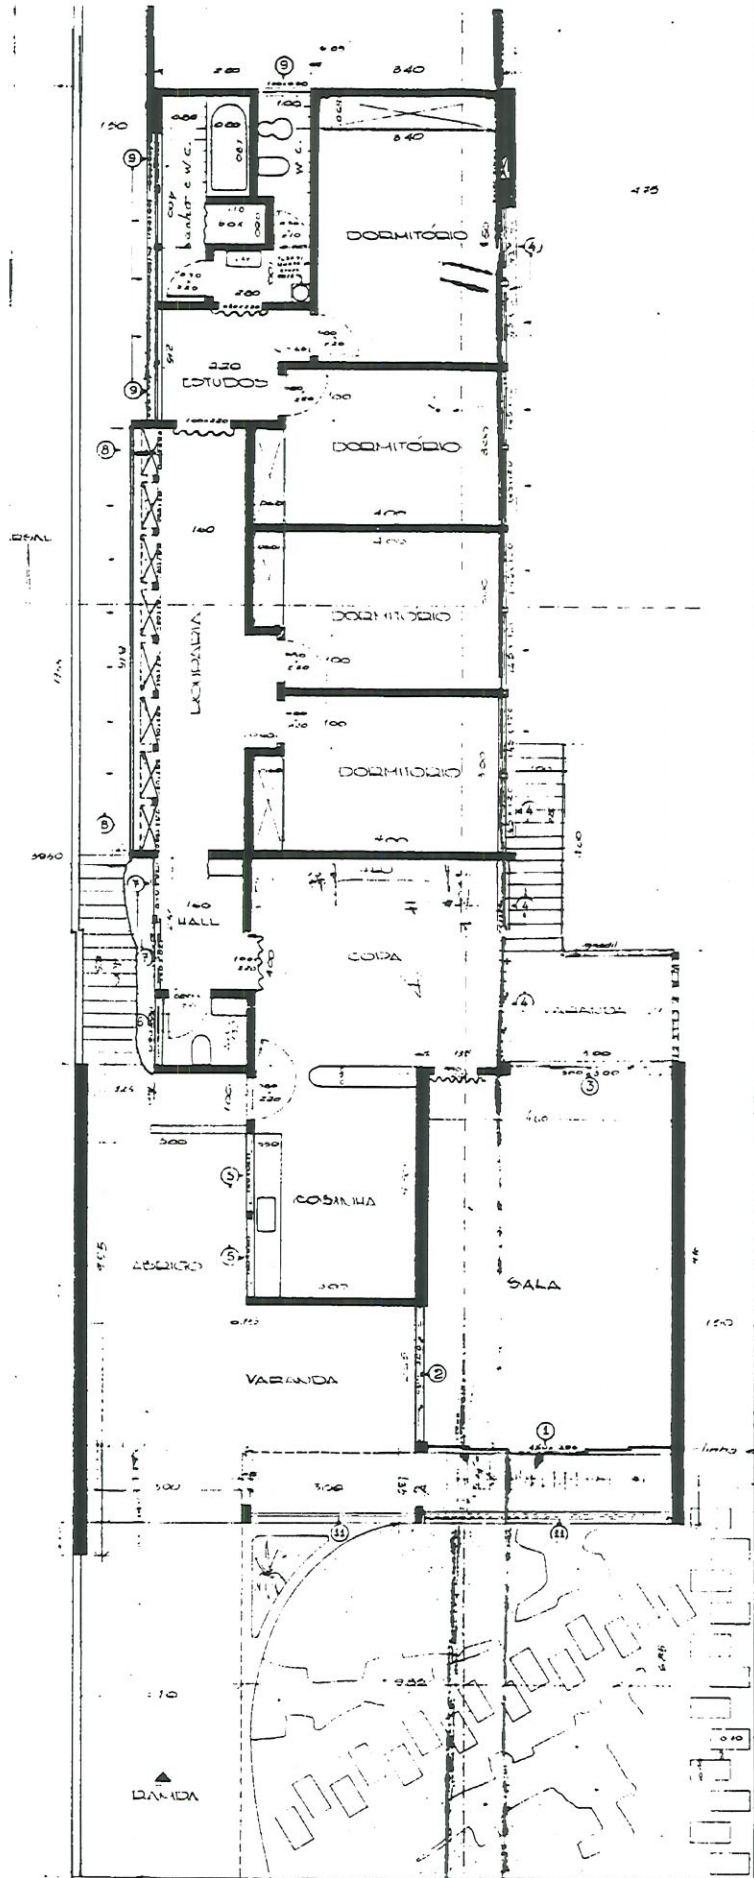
Residência Sebastião Caparelli – 1959 - Planta
